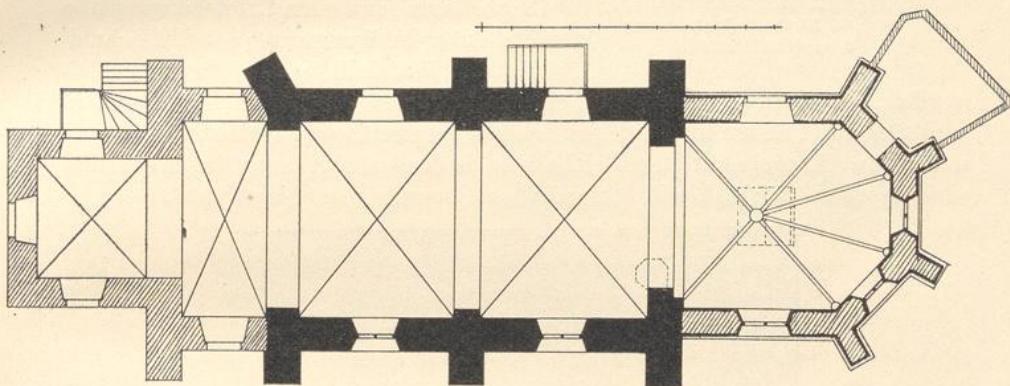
Kirche in Barkhausen: Grundriss (1:250).
